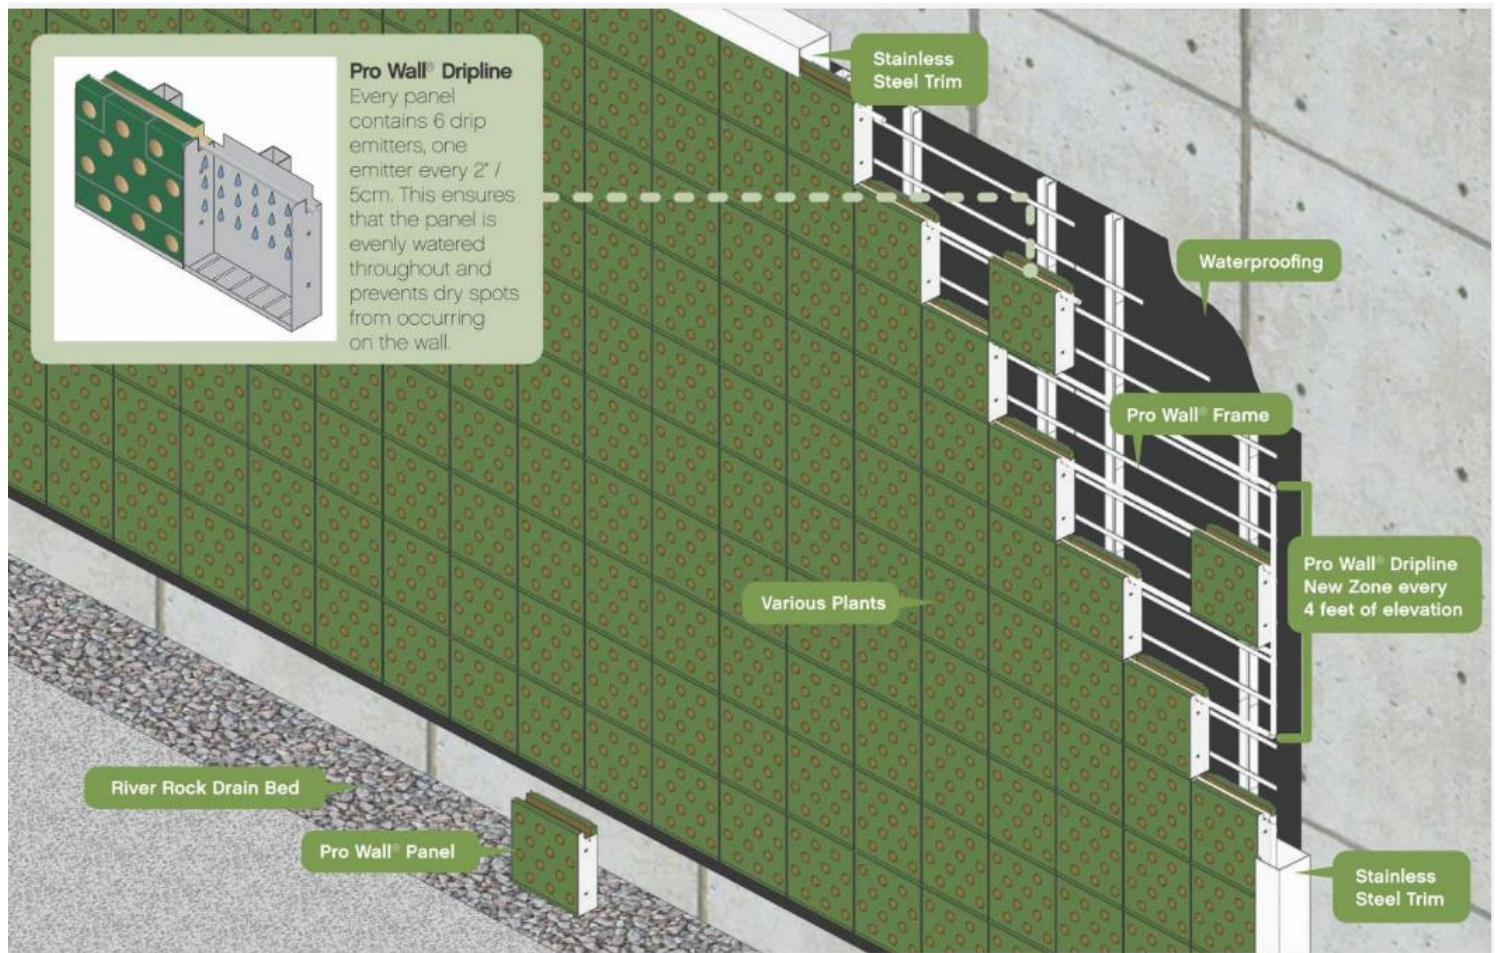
Vista de la instal·lació del sistema *Pro Wall*.
